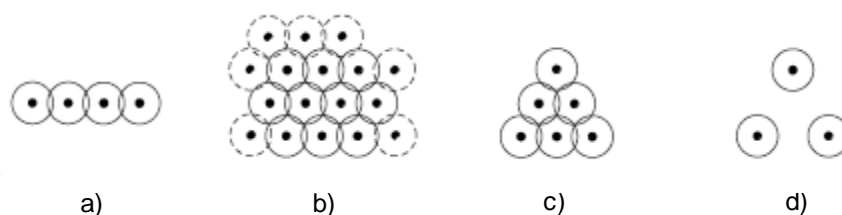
Disposição característica de colunas de *jet grouting* (Giuseppe e Giovanni, 2008):
